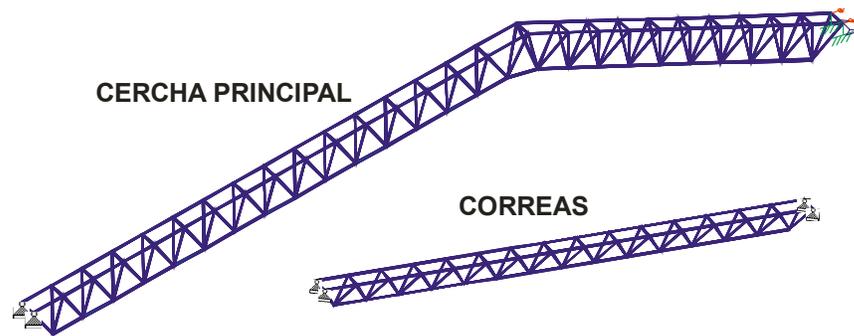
Modelo cubierta I.E.M. Santa Teresita – El Encano
